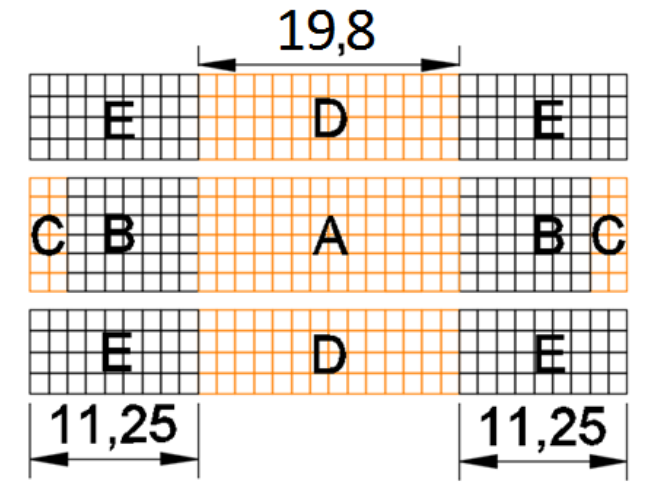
Dimensiones de las zonas de armado. Fuente: SAP2000
